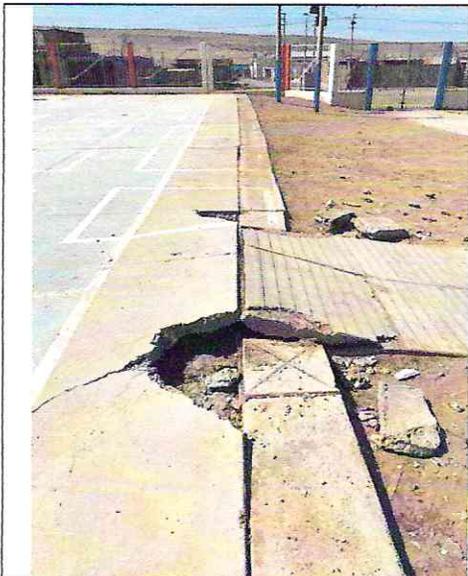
Piso de losa deportiva con concreto colapsado.
